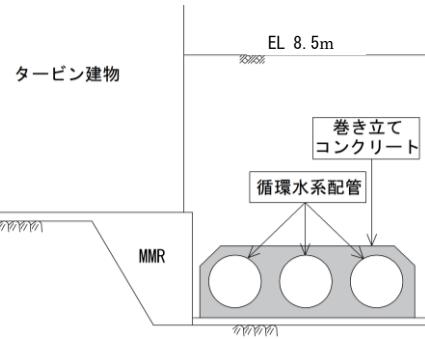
循環水排水路断面図(2/2) (①-①断面)
